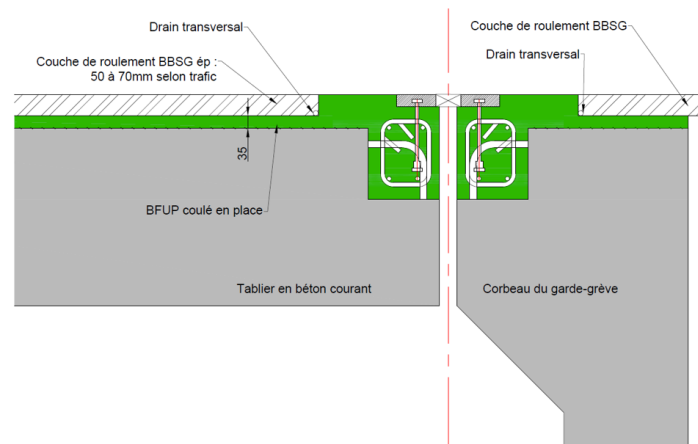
Disposition recommandée au niveau d'un solin de joint de chaussée (option d'un solin entièrement BFUP)
